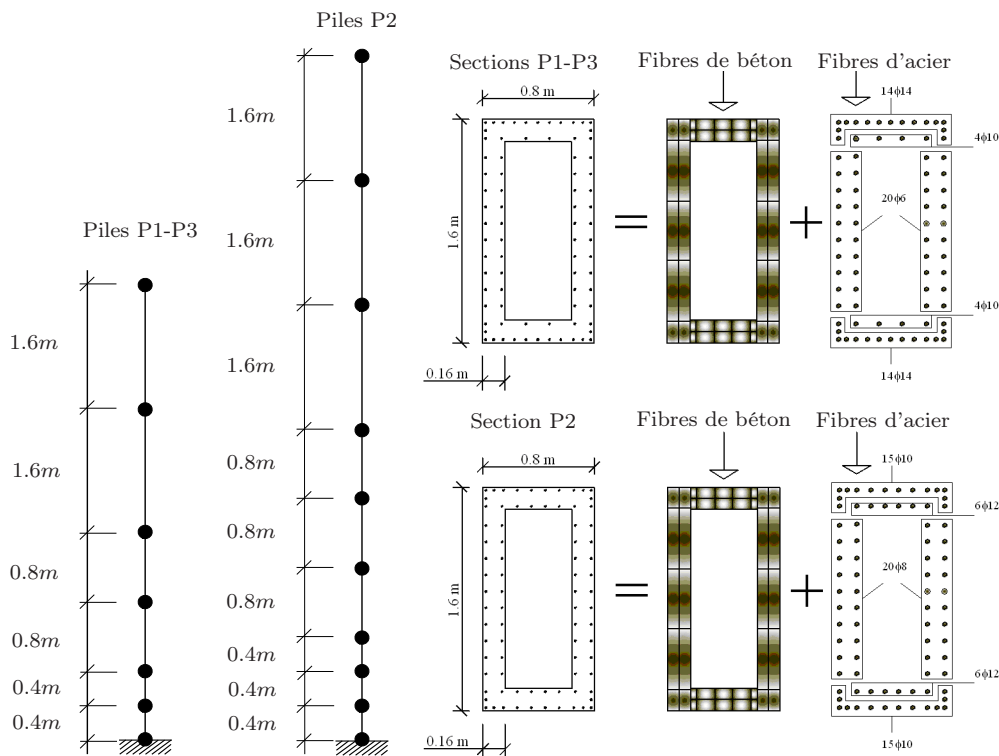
Viaduc: détail de la discrétisation des poutres multifibres pour les piles P1, P2 et P3.
